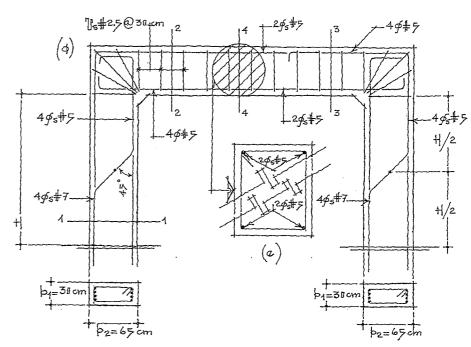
Corte transversal 1-1 y planta, (b).
